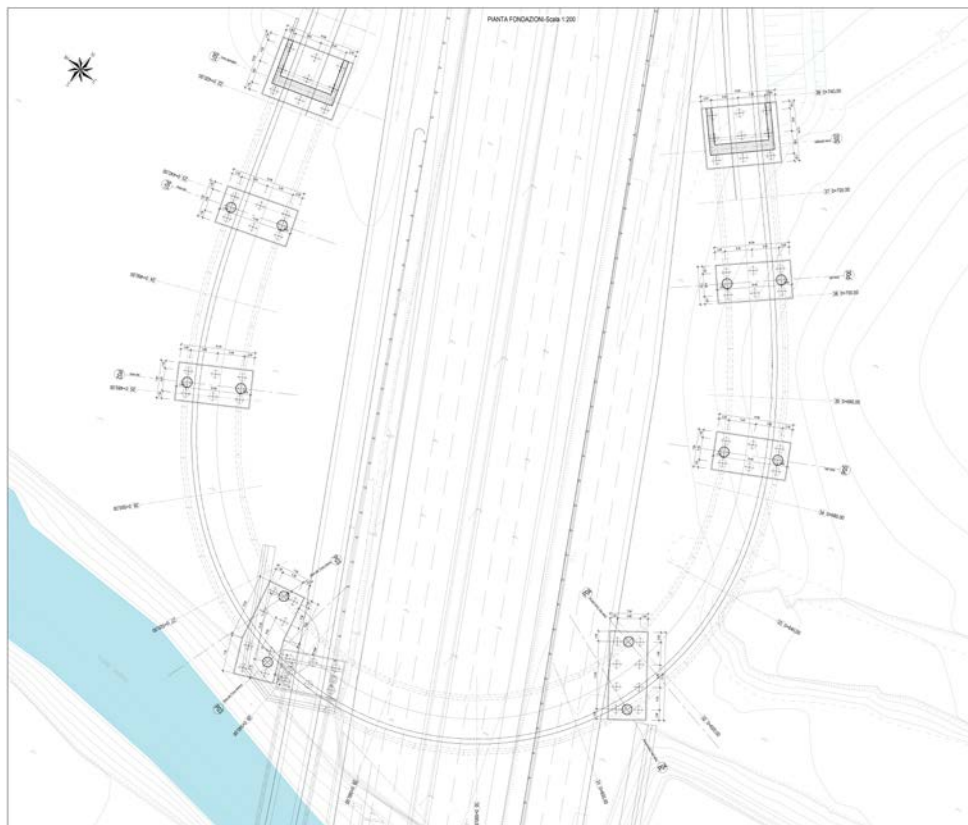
Viadotto "Rampa di inversione sud": pianta delle fondazioni
